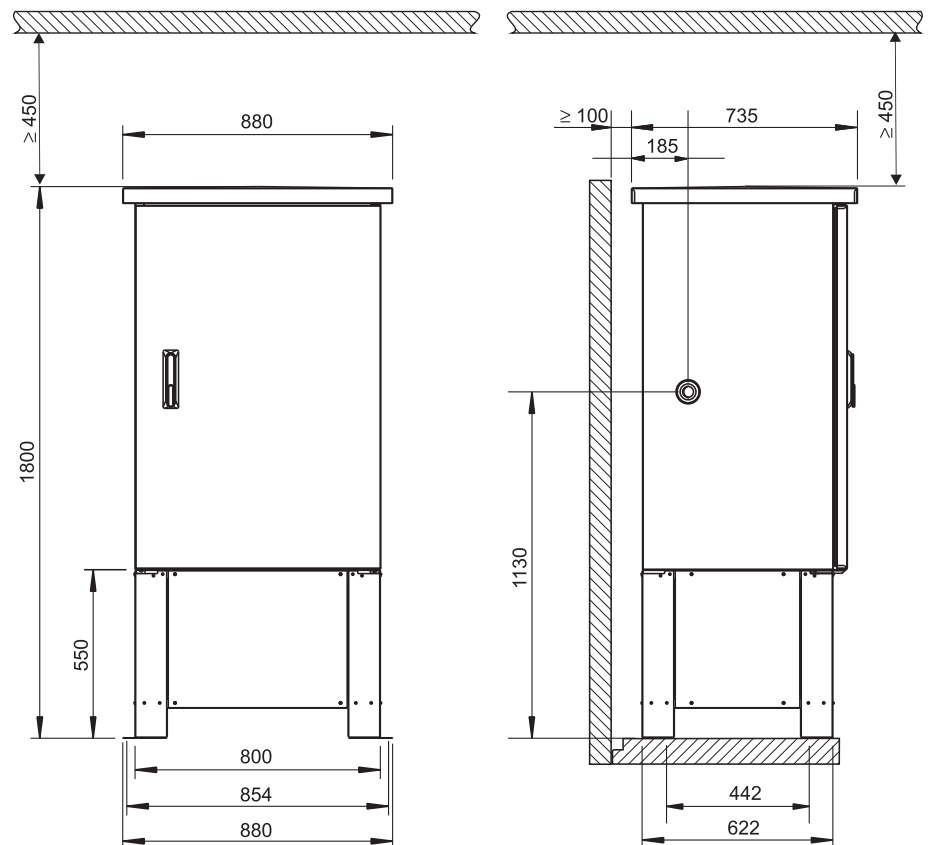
Standardschrank mit Schrankunterbau (Abmessungen in mm)
